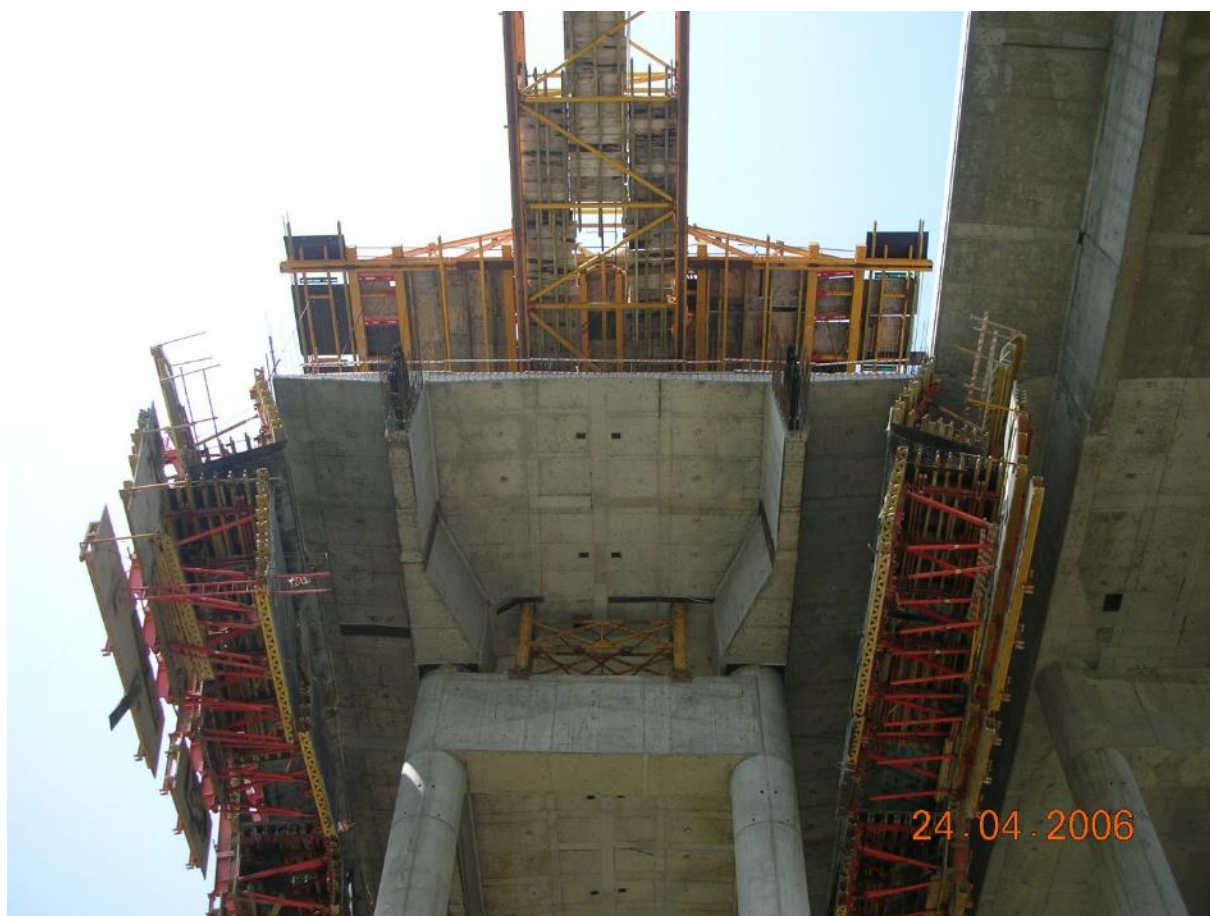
Vista inferior do tabuleiro durante o avanço da vida de lançamento
